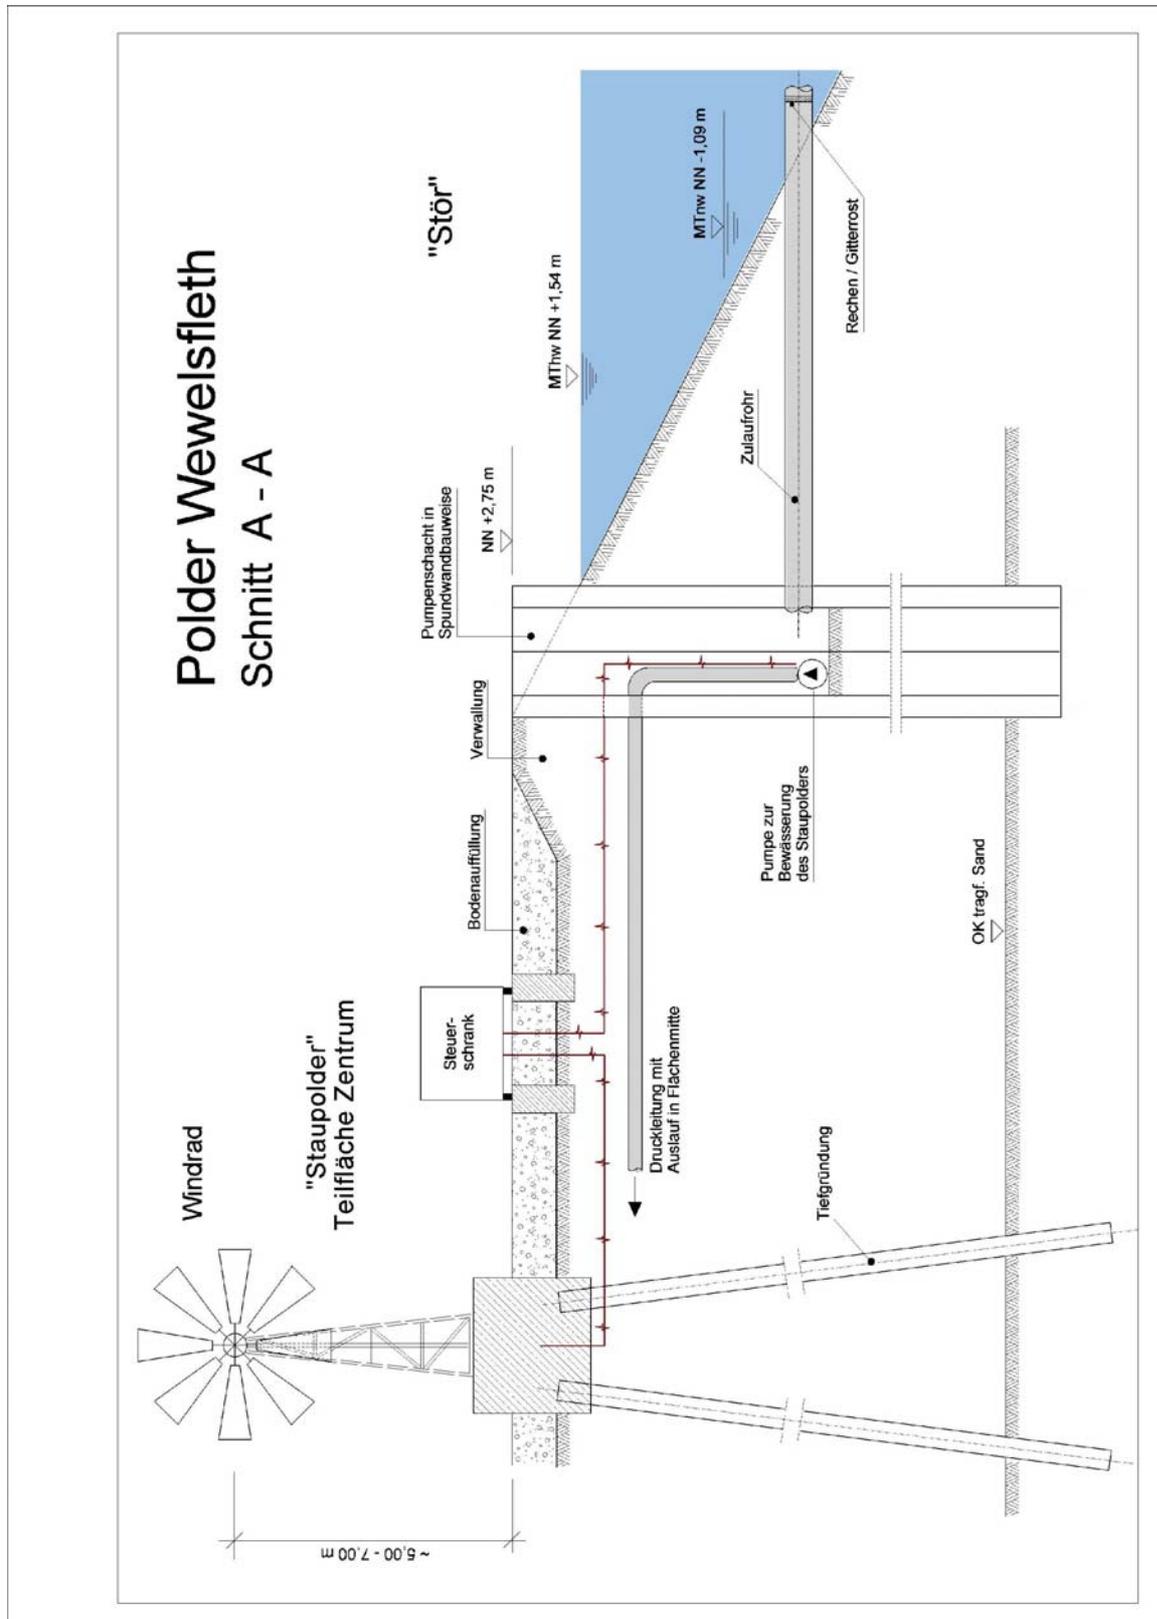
Prinzipskizze zur Bewässerung des Polders – „Windrad, Pumpwerk“
